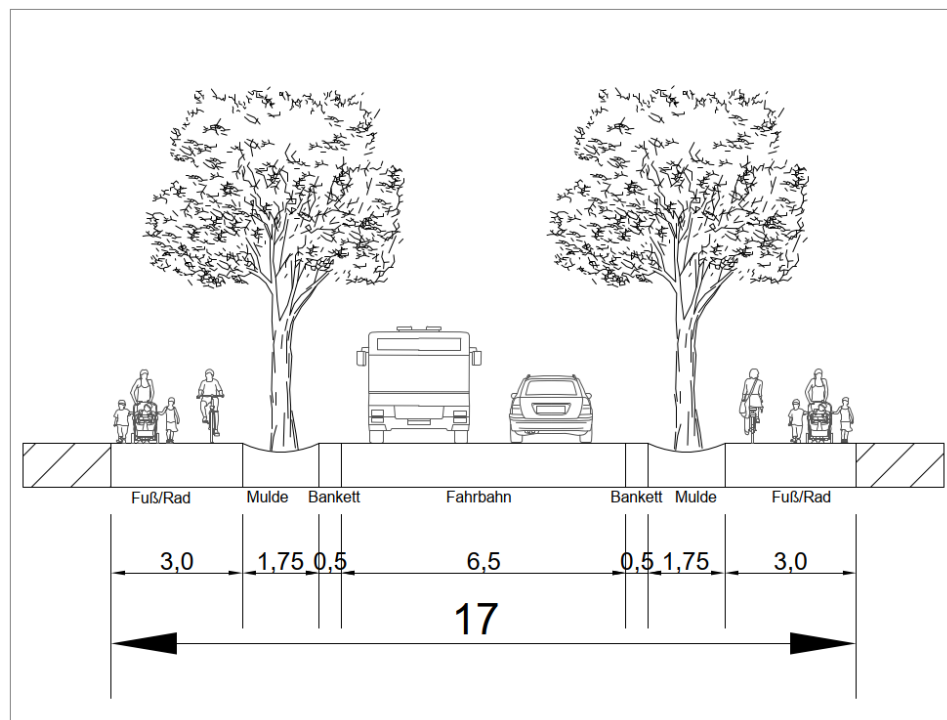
Straßenquerschnitt 17m (Planstraße 2)
